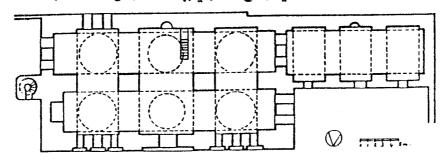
مسقط أفقي لجامع الأحمدية ببغداد (عن Ulucam).
